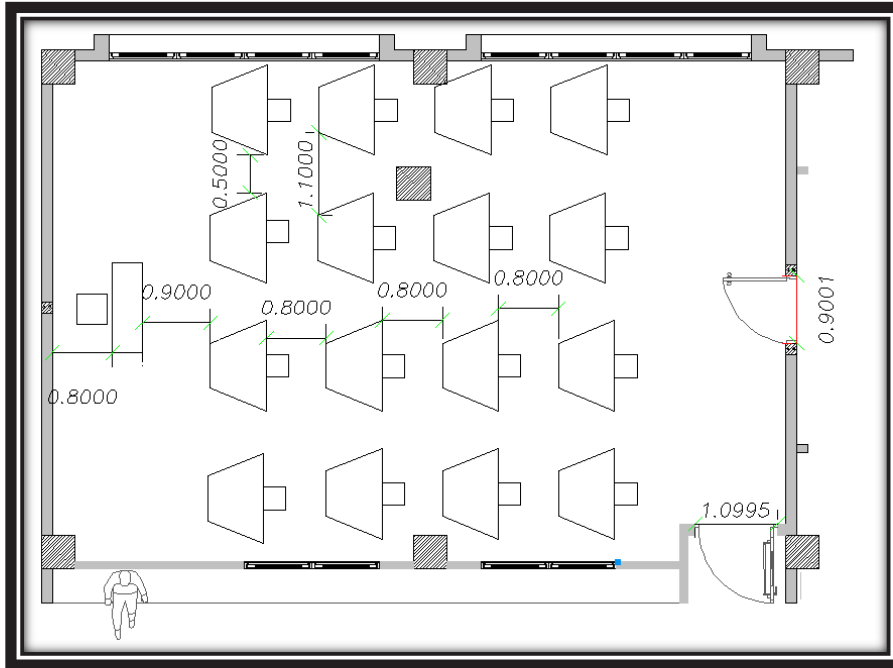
Planta aula preescolar con mesas grupales de PVC
